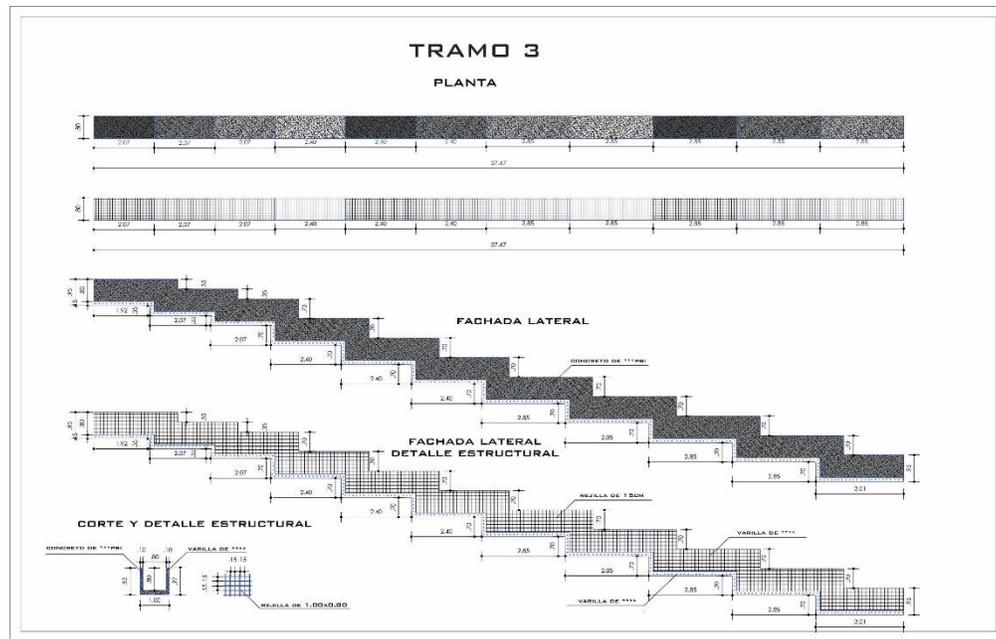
Plano tramo 3 perfil longitudinal, planta y detalle estructural.
